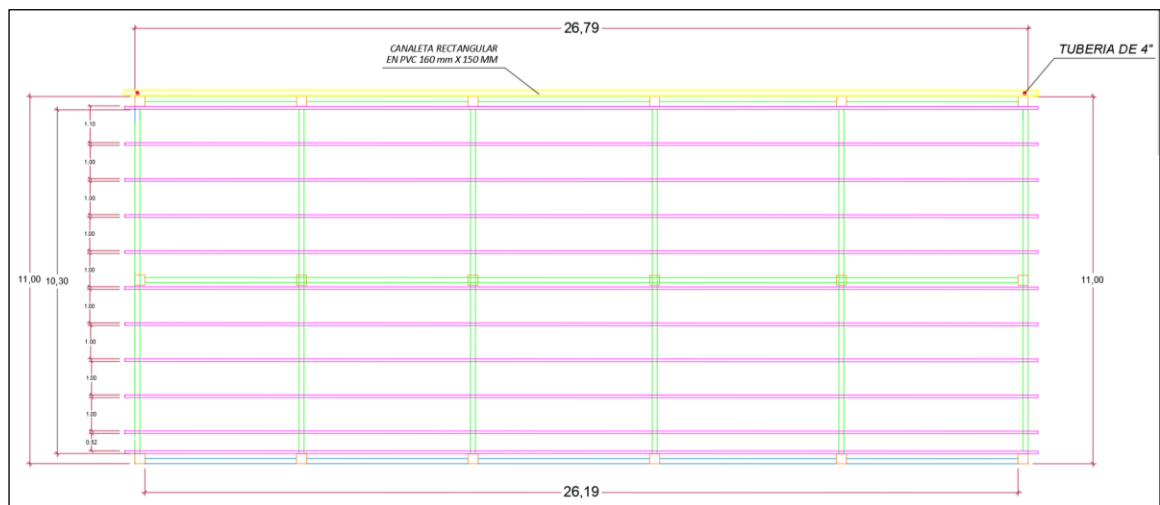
Vista en planta de entramado de perfil de acero, de la estructura 4 del Centro de Desarrollo Infantil.
